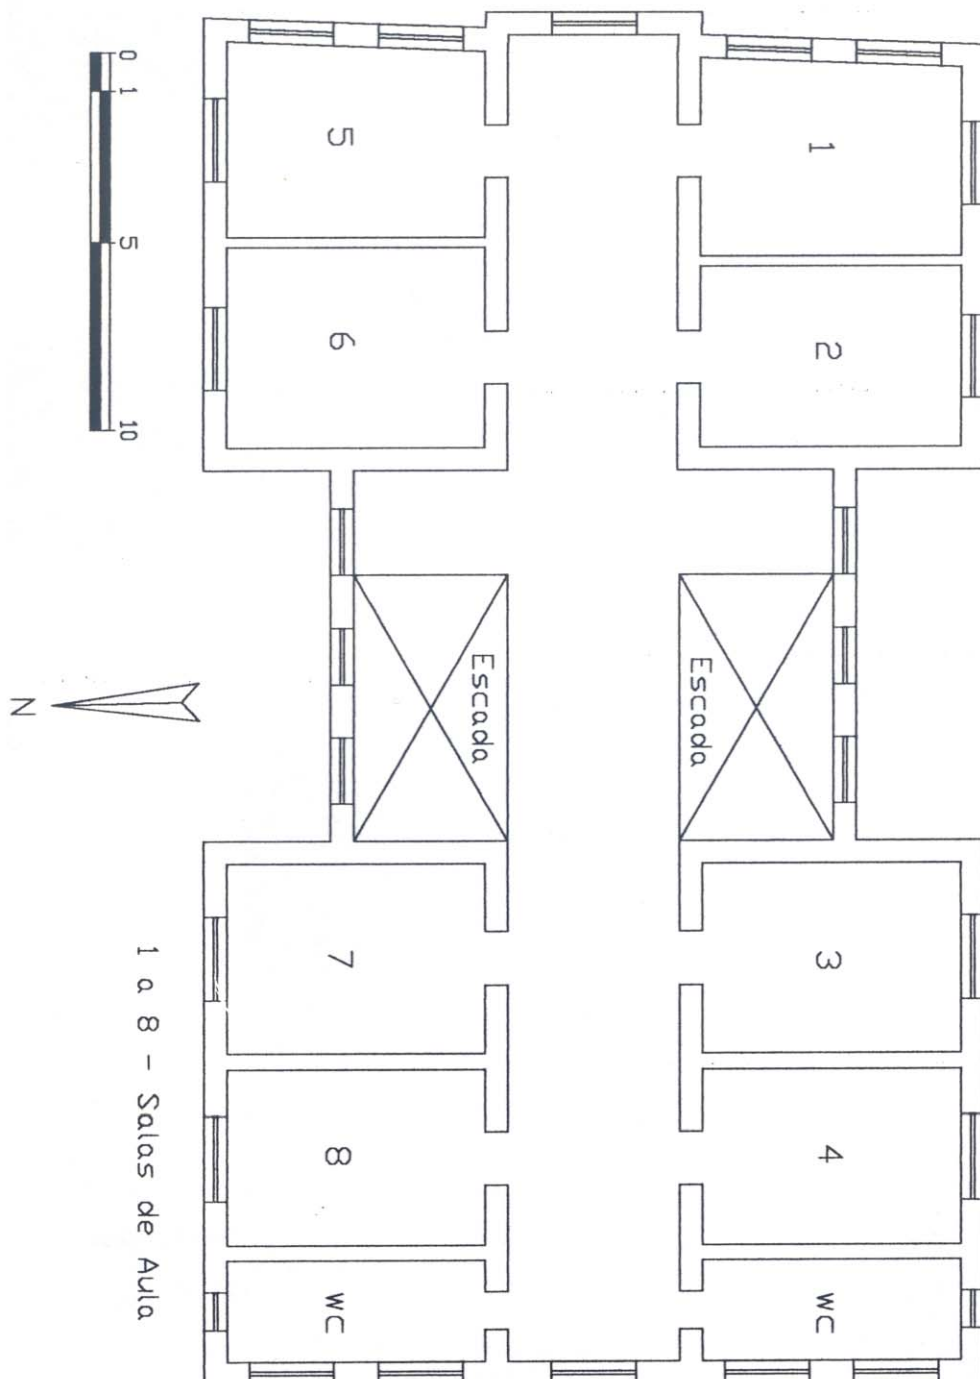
Planta baixa - Distribuição das salas de aula / 2º e 3º pavimentos
